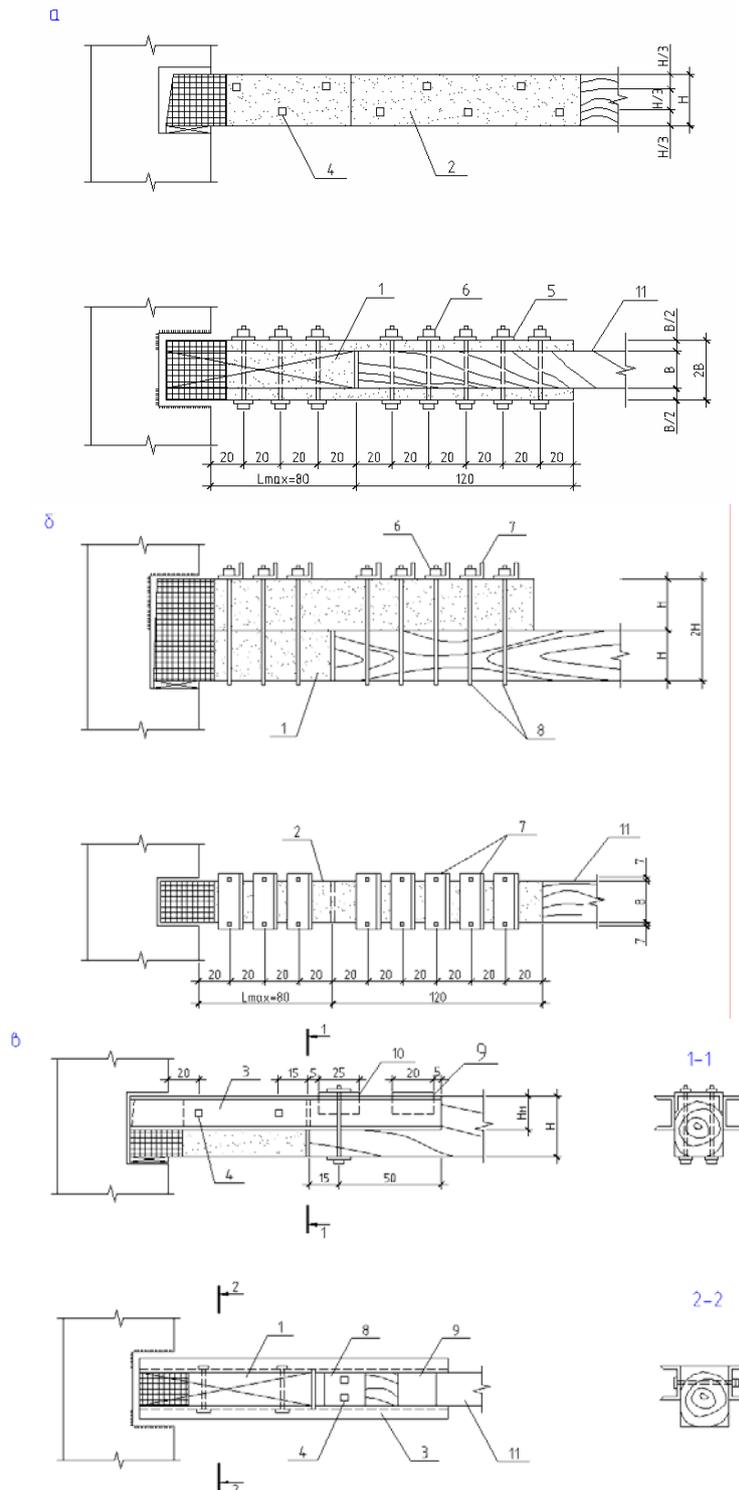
Усиление концов деревянных балок: *а* – боковыми накладками; *б* – накладками сверху; *в* – боковыми стальными накладками; 1 – вкладыш; 2 – деревянная накладка; 3 – стальная накладка; 4 – болт диаметром 16 – 18 мм; 5 – металлическая шайба; 6 – гайка; 7 – уголок 75×5 мм; 8 – хомут; 9, 10 – накладки из швеллеров; 11 – усиливаемая существующая балка
